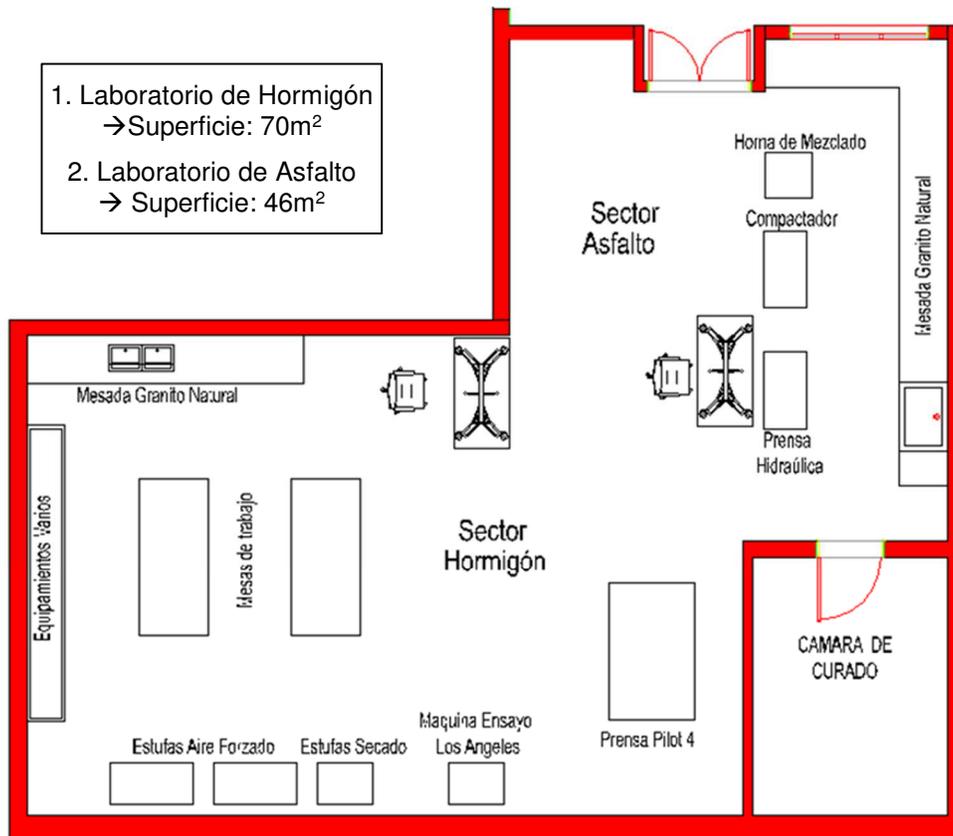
Planta y distribución de espacios de los laboratorios de hormigón y asfalto.
